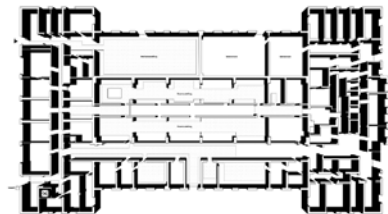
Entwurf HG Merz 2; das Hauptgebäude bleibt in der jetzigen Gestalt vollständig erhalten. Der Ausstellungsrundgang erfolgt auf einem reversibel verlegtem Erschließungssteg (Stahlbauweise), Einbau einer Fahrstuhlanlage und drei behindertengerechten Hubanlagen.
